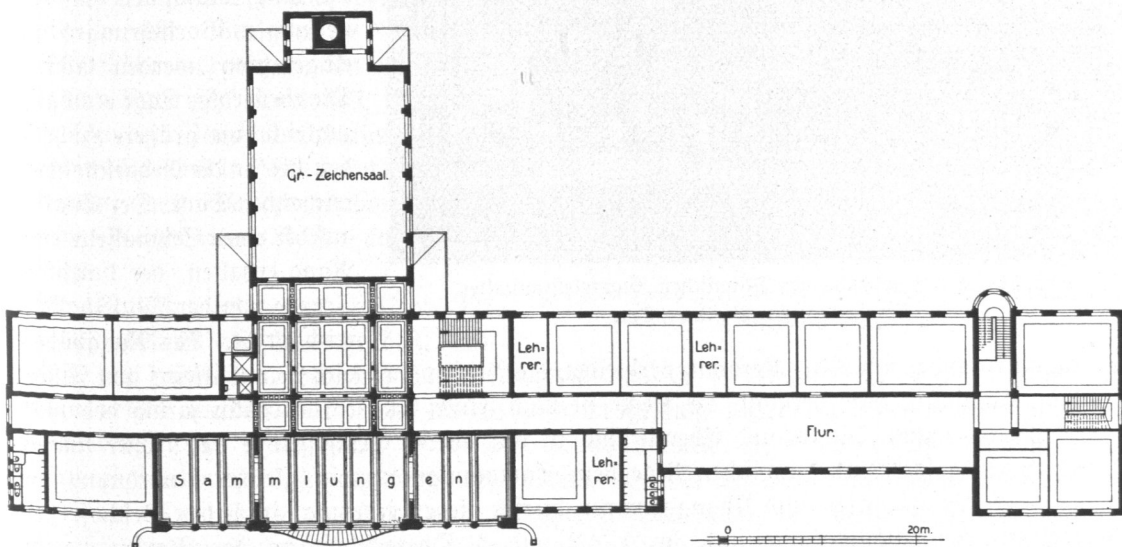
Hauptgebäude der Technischen Staatslehranstalten, Grundriß, 1. Obergesch.ß.
